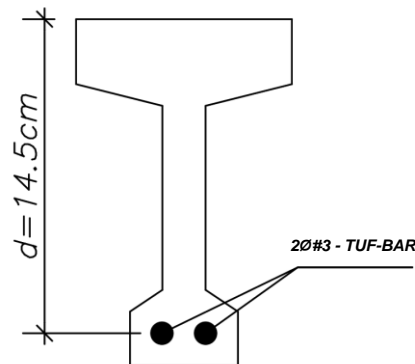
Detalle de la ubicación y cantidad del refuerzo de GFRP
